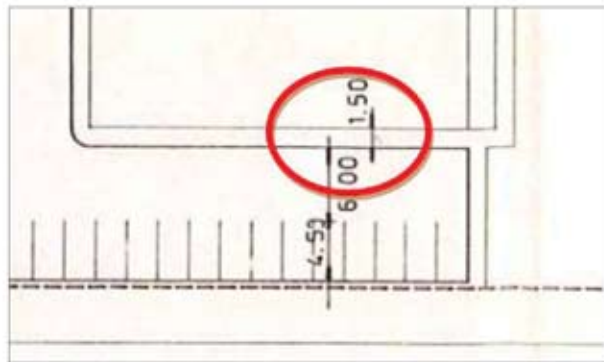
Extracto del plano del Proyecto de Dotación de Infraestructuras
